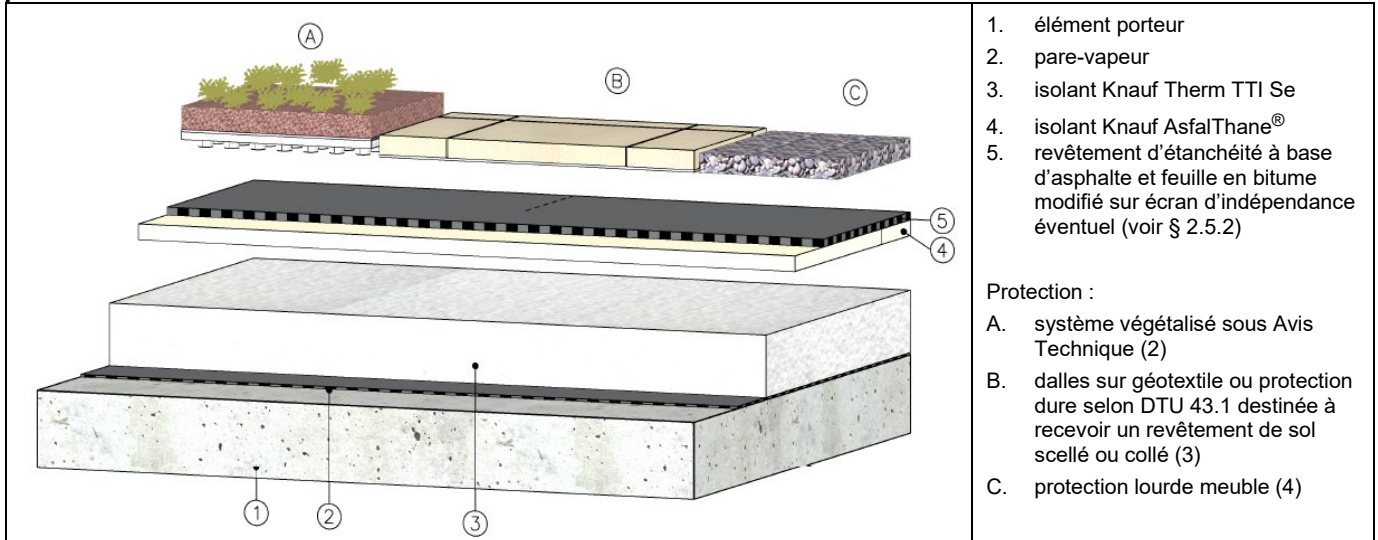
Exemple de toiture-terrasse avec élément porteur en maçonnerie ou en dalles de béton cellulaire autoclavé (1), Knauf Therm TTI Se + Knauf AsfalThane® sous revêtement d'étanchéité en asphalte et protection lourde
